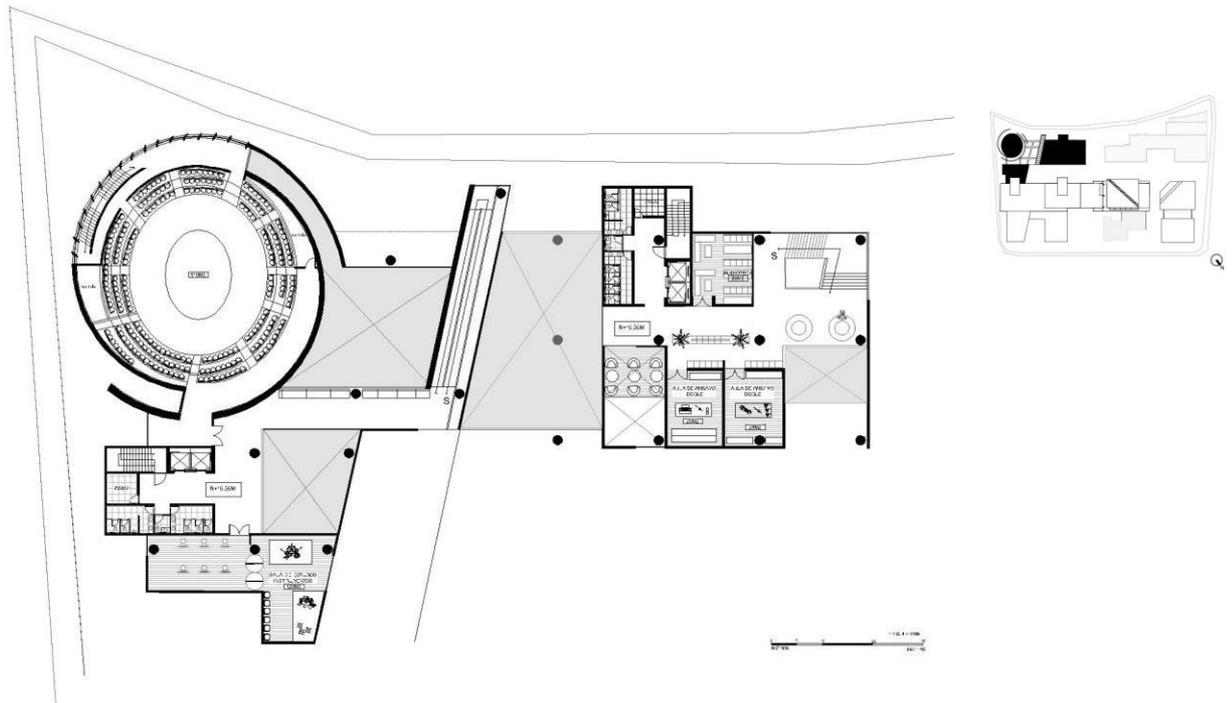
Planta tercer nivel. N+16.56m. Elaboración propia.
